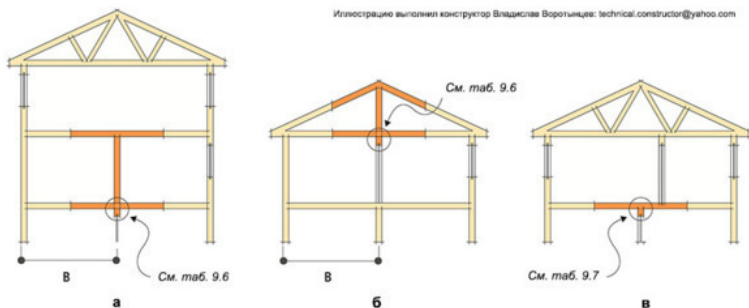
Выбор сечения перемычек в несущих внутренних стенах в зависимости от характера загруженности: а – внутренние стены, несущие нагрузку от двух междуэтажных перекрытий; б – внутренние стены, несущие нагрузку от кровли; в – внутренние стены, несущие нагрузку от одного междуэтажного перекрытия
